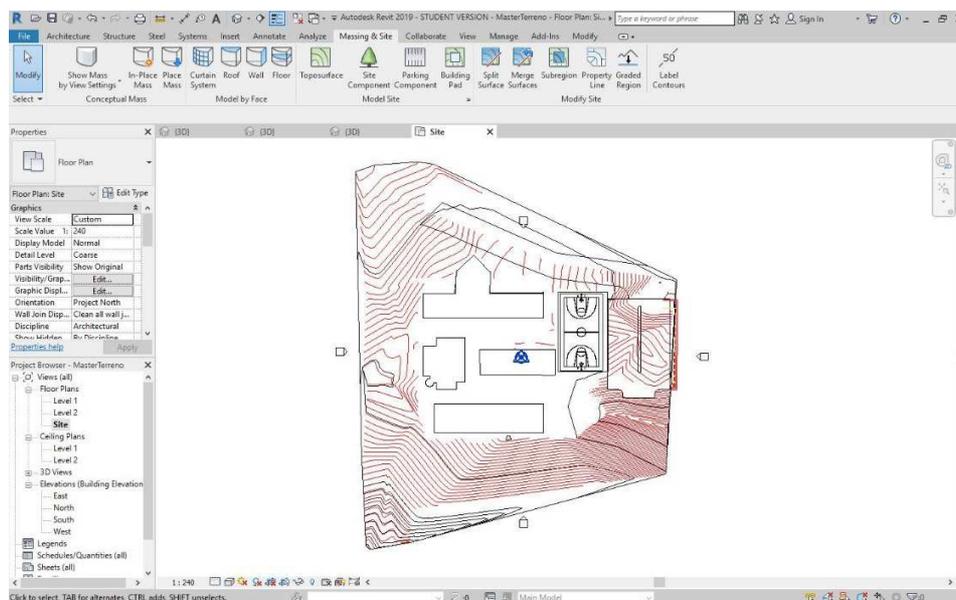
Vista en planta de la plataforma de construcción, fuente: Revit 2019.
